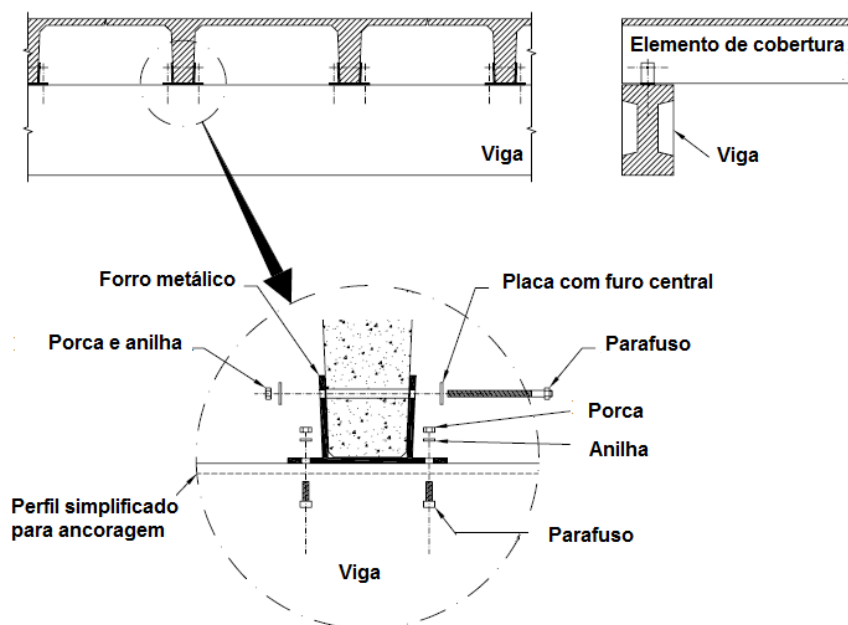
Intervenção para a ligação entre elemento de cobertura/pavimento e vigas - Ordem 2 – Tipo 1 [16]
